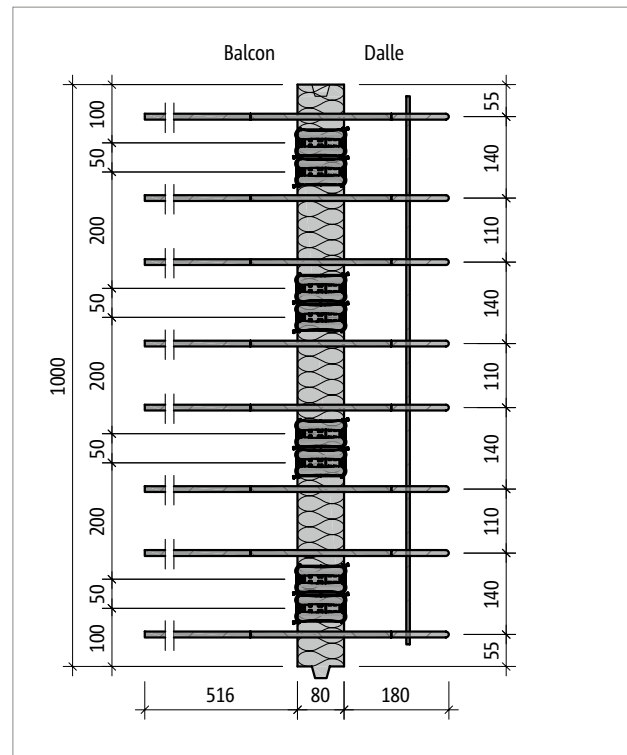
Schöck Isokorb® T Type Q-E-W-V5 : Plan de base du produit
